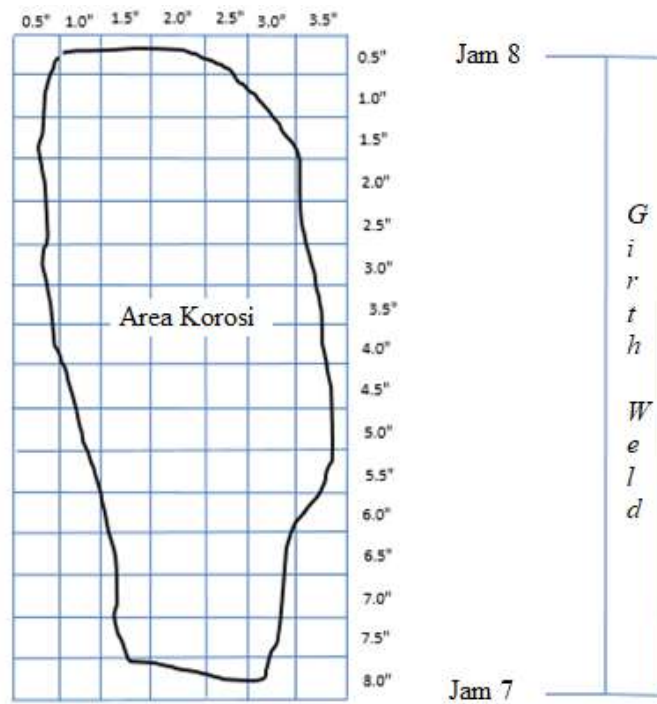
Ilustrasi inspeksi menggunakan Krautkramer
